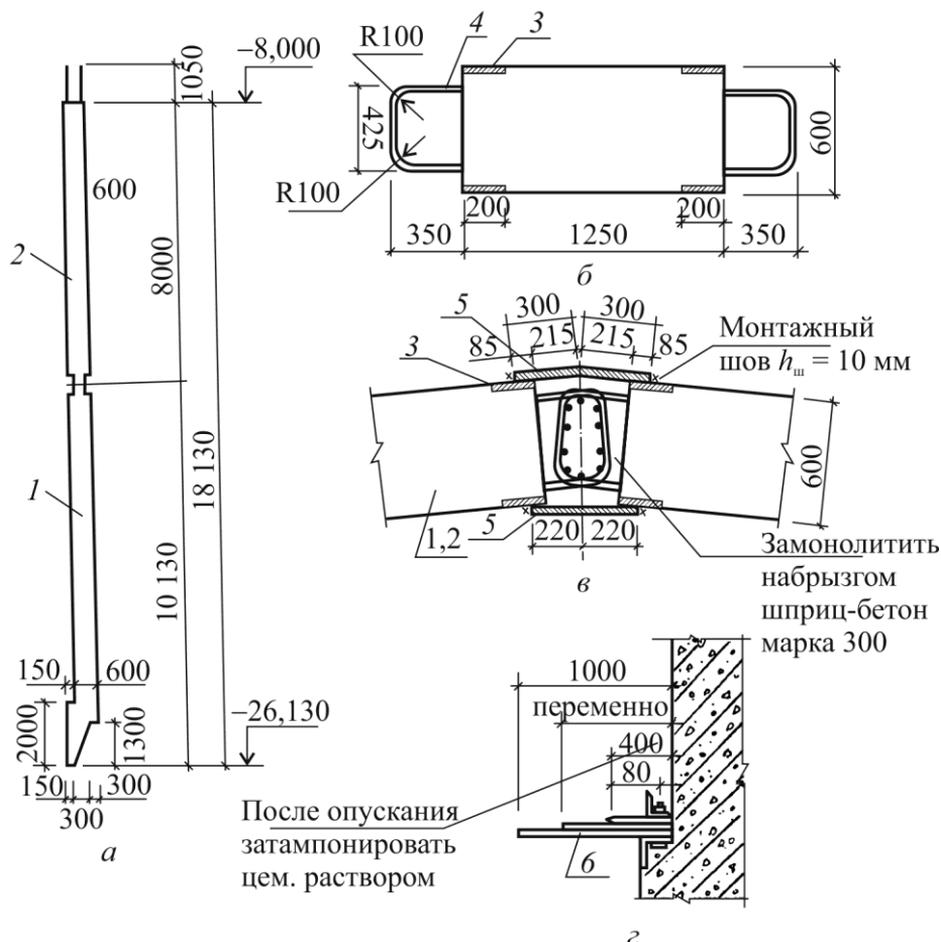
Конструкция опускного колодца из сборных панелей:
